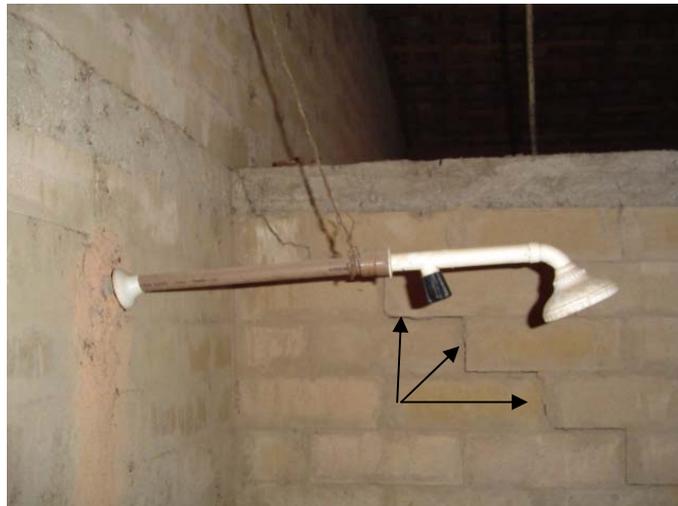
Fissura na junta da alvenaria em um banheiro
